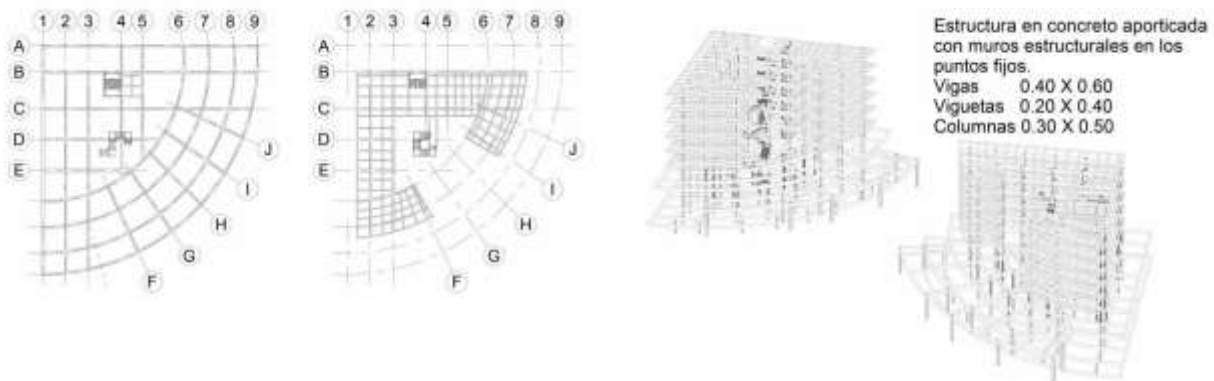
Plantas Estructurales Esc 1:200 y 3D Estructura
